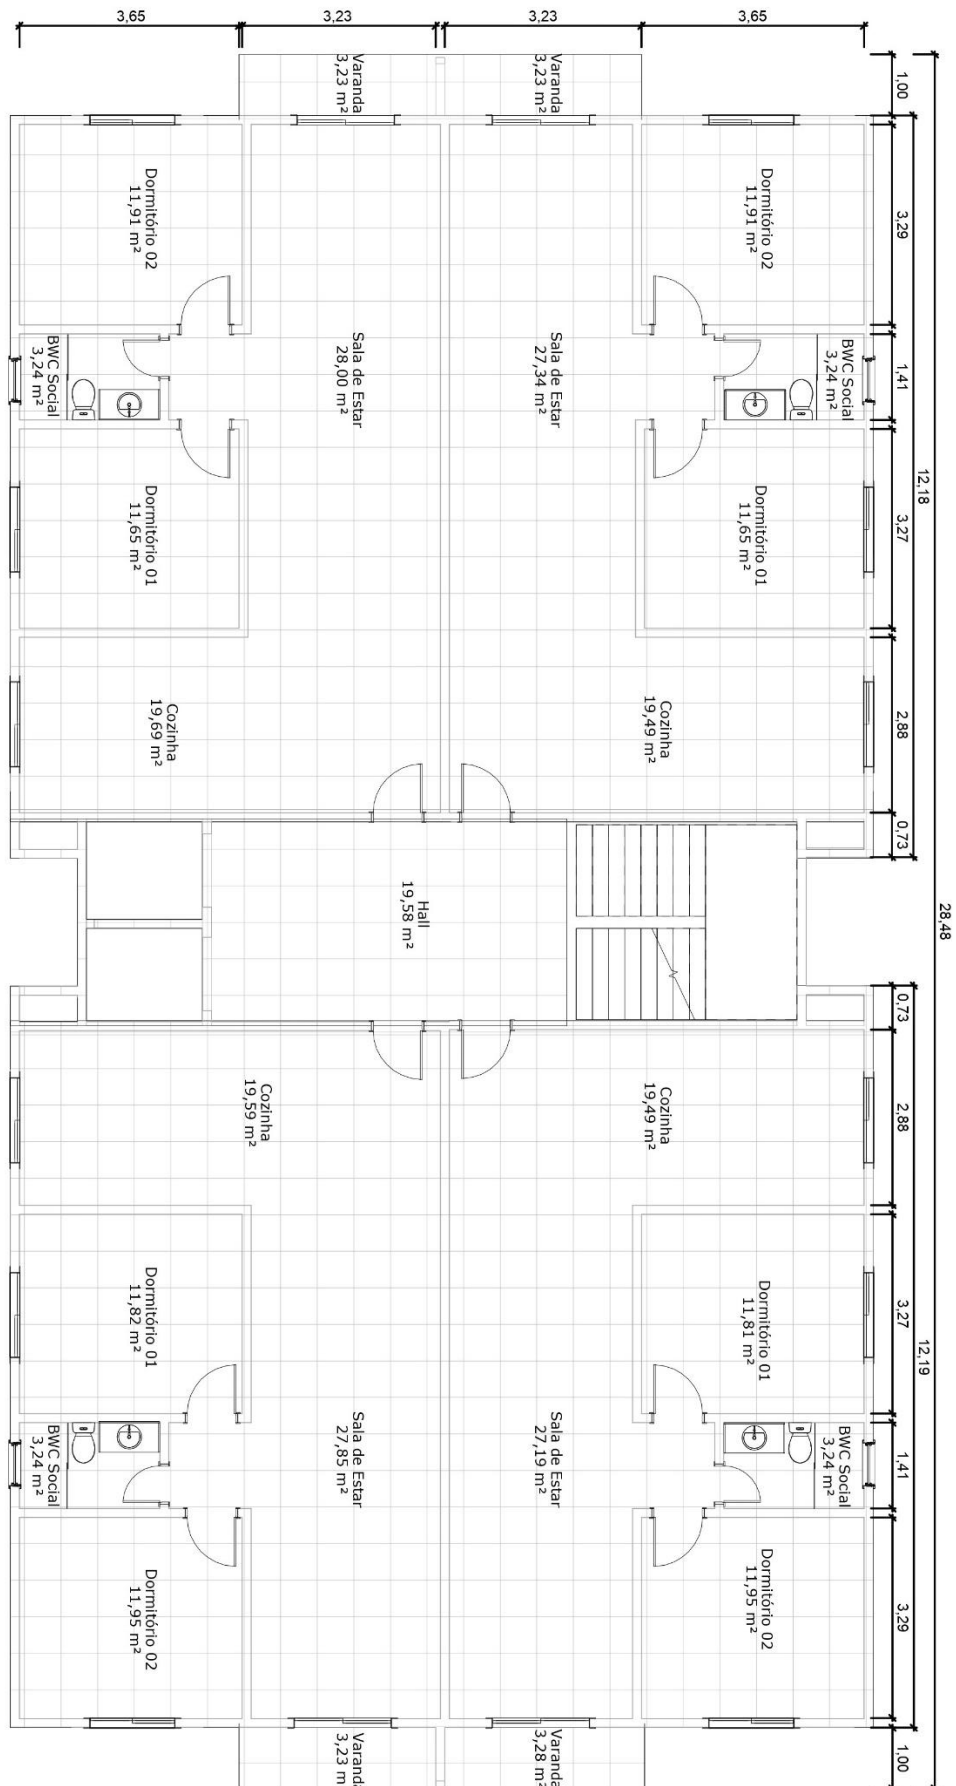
Planta baixa do pavimento tipo. Fonte: Autor (2022).
